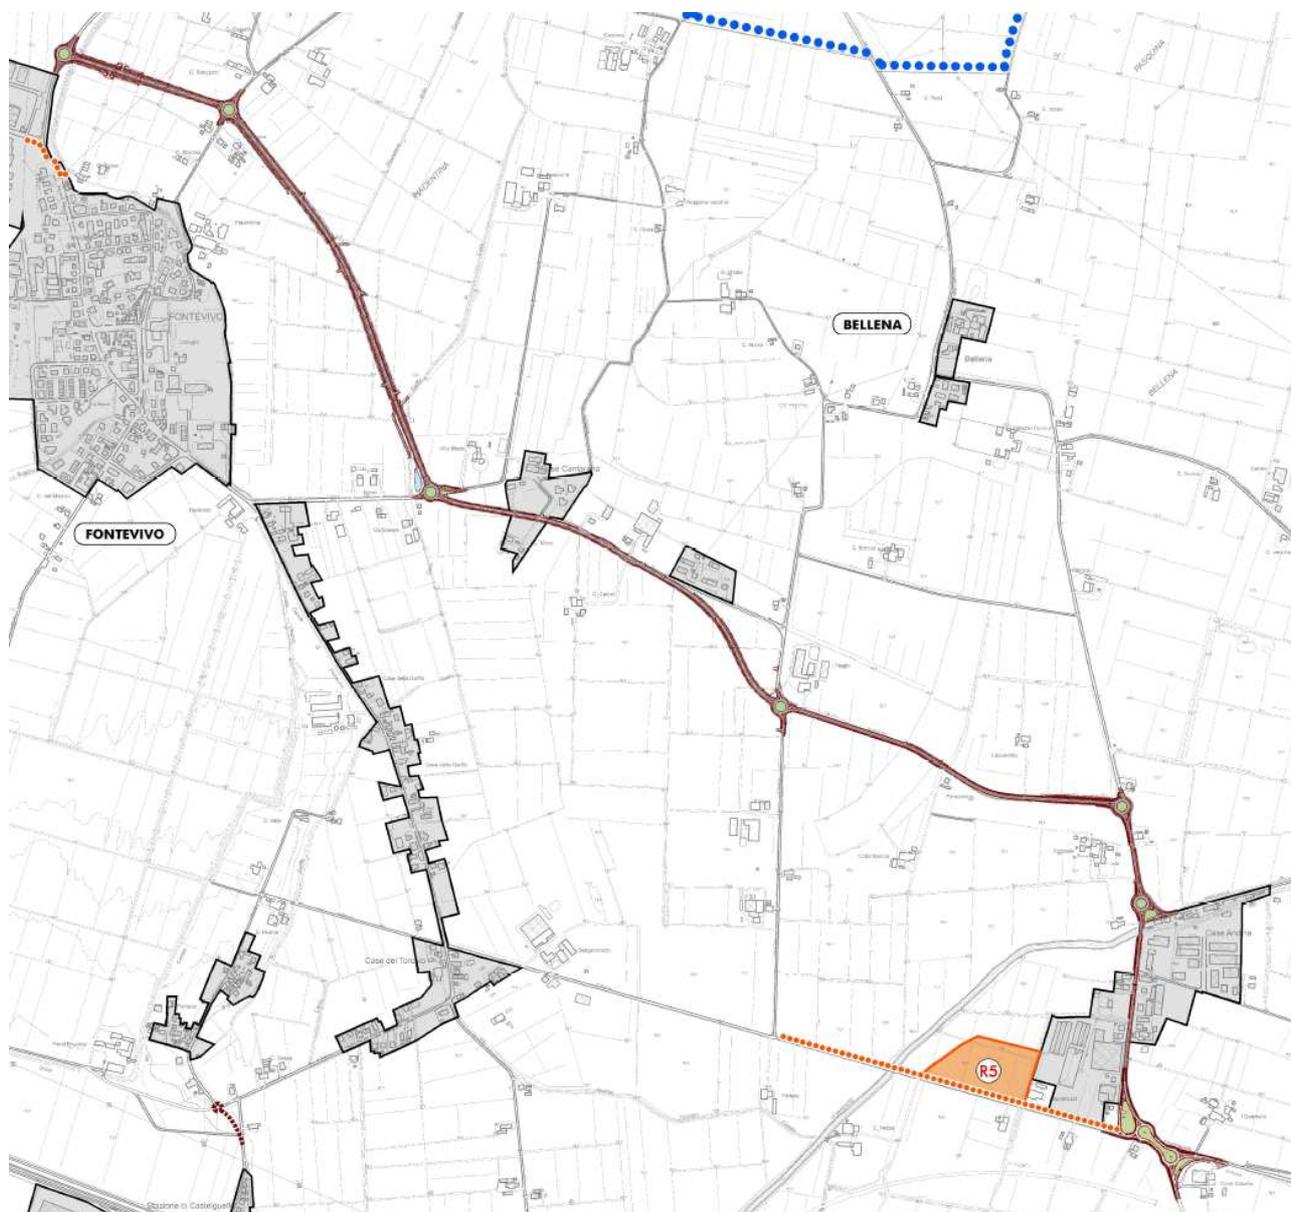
STRALCIO DELLA TAV. POC.1 “INDIVIDUAZIONE AMBITI E INTERVENTI PUBBLICI PREVISTI DAL POC”
